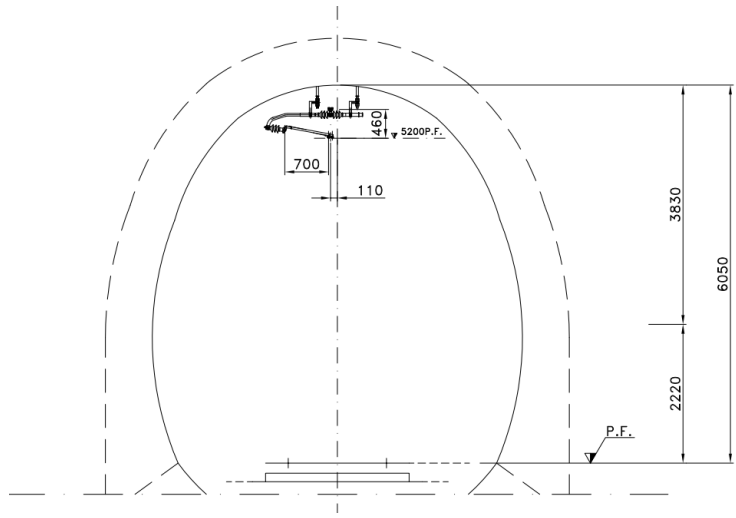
Disposizione sospensione a traversa isolata in galleria
